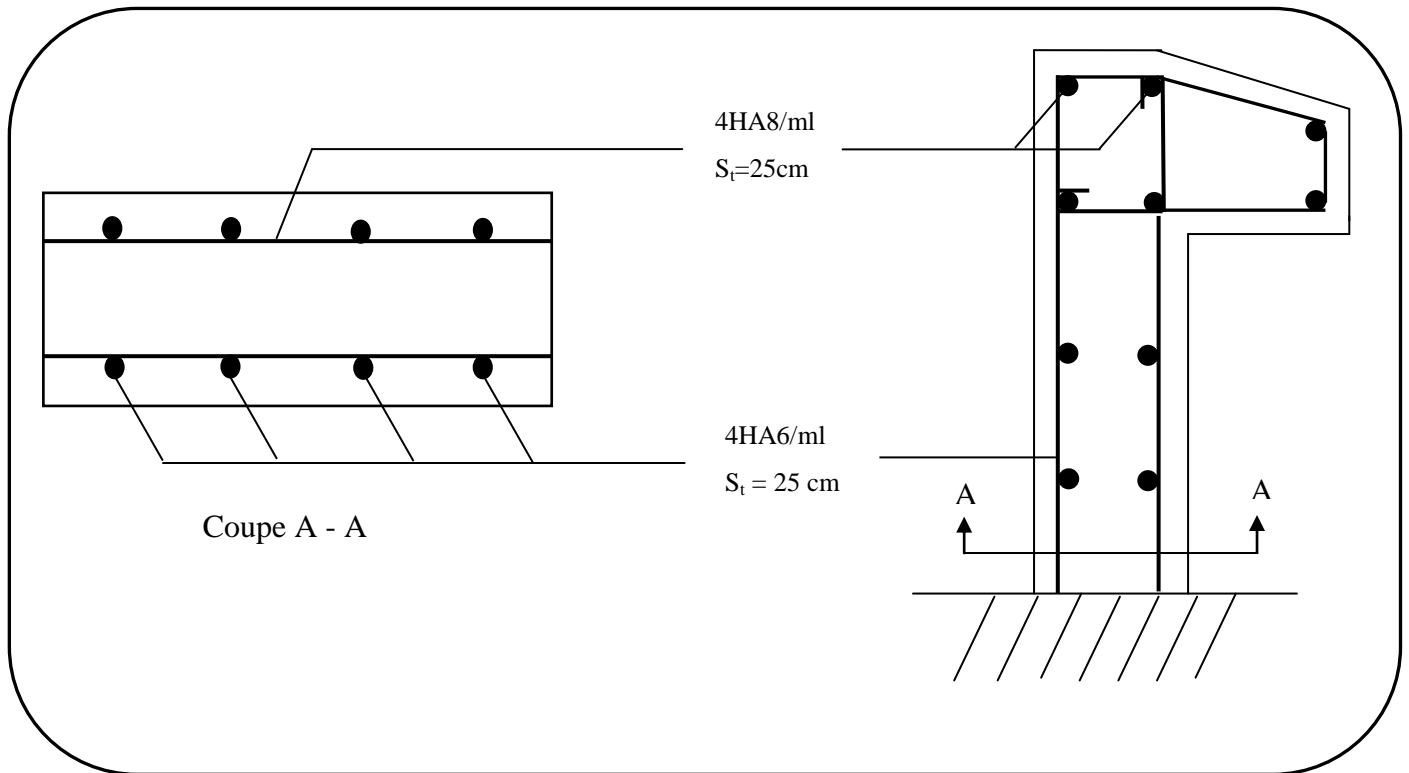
Schéma de ferrailage de l'acrotère
